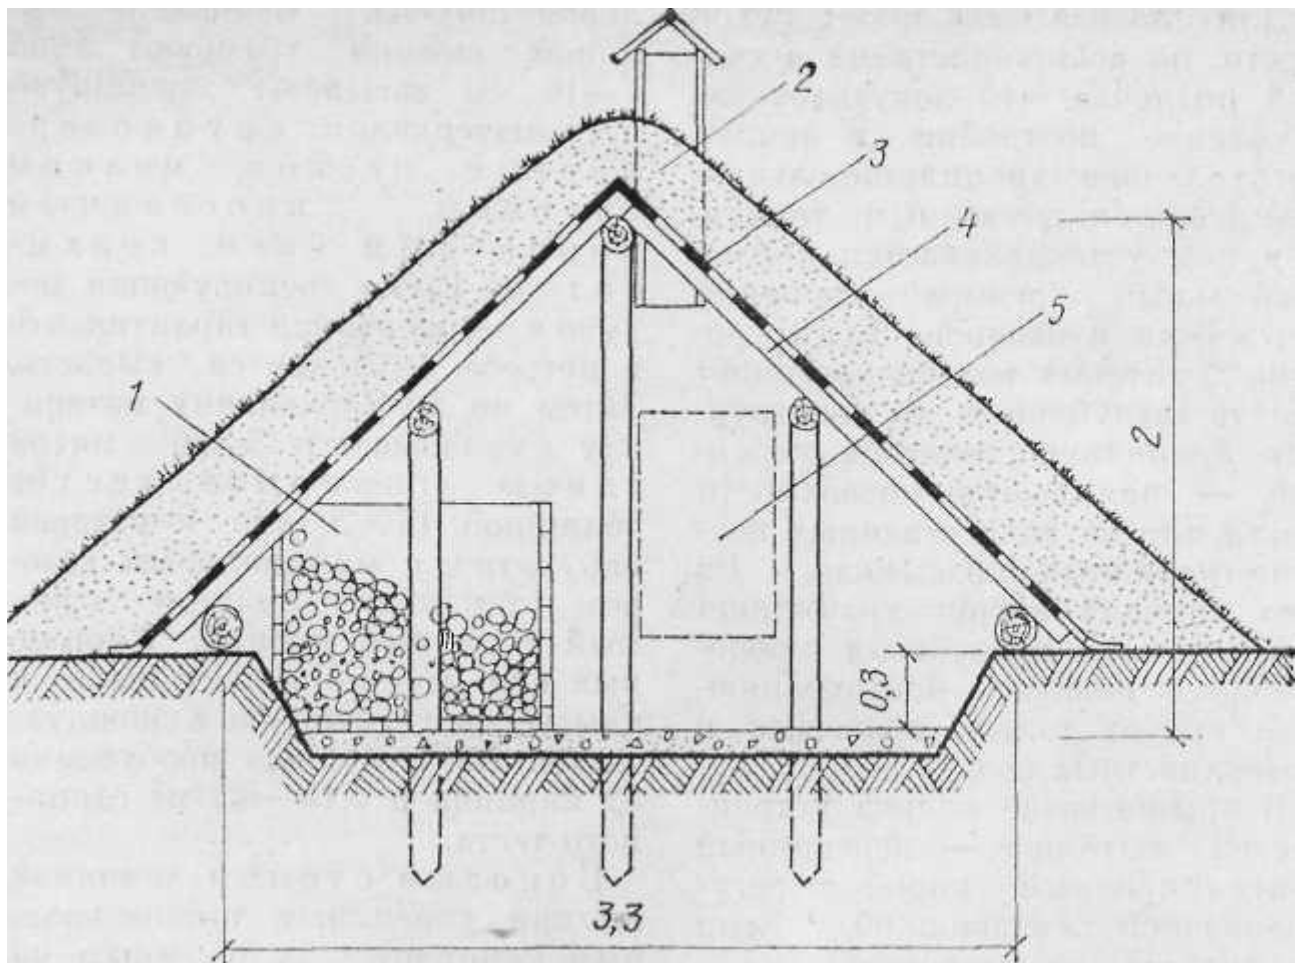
Наземное хранилище (лабаз овощной): 1 – заком; 2 – обваловка грунтом; 3 – рубероид; 4 – дощатая обрешетка, стропила; 5 – дверца-лаз
